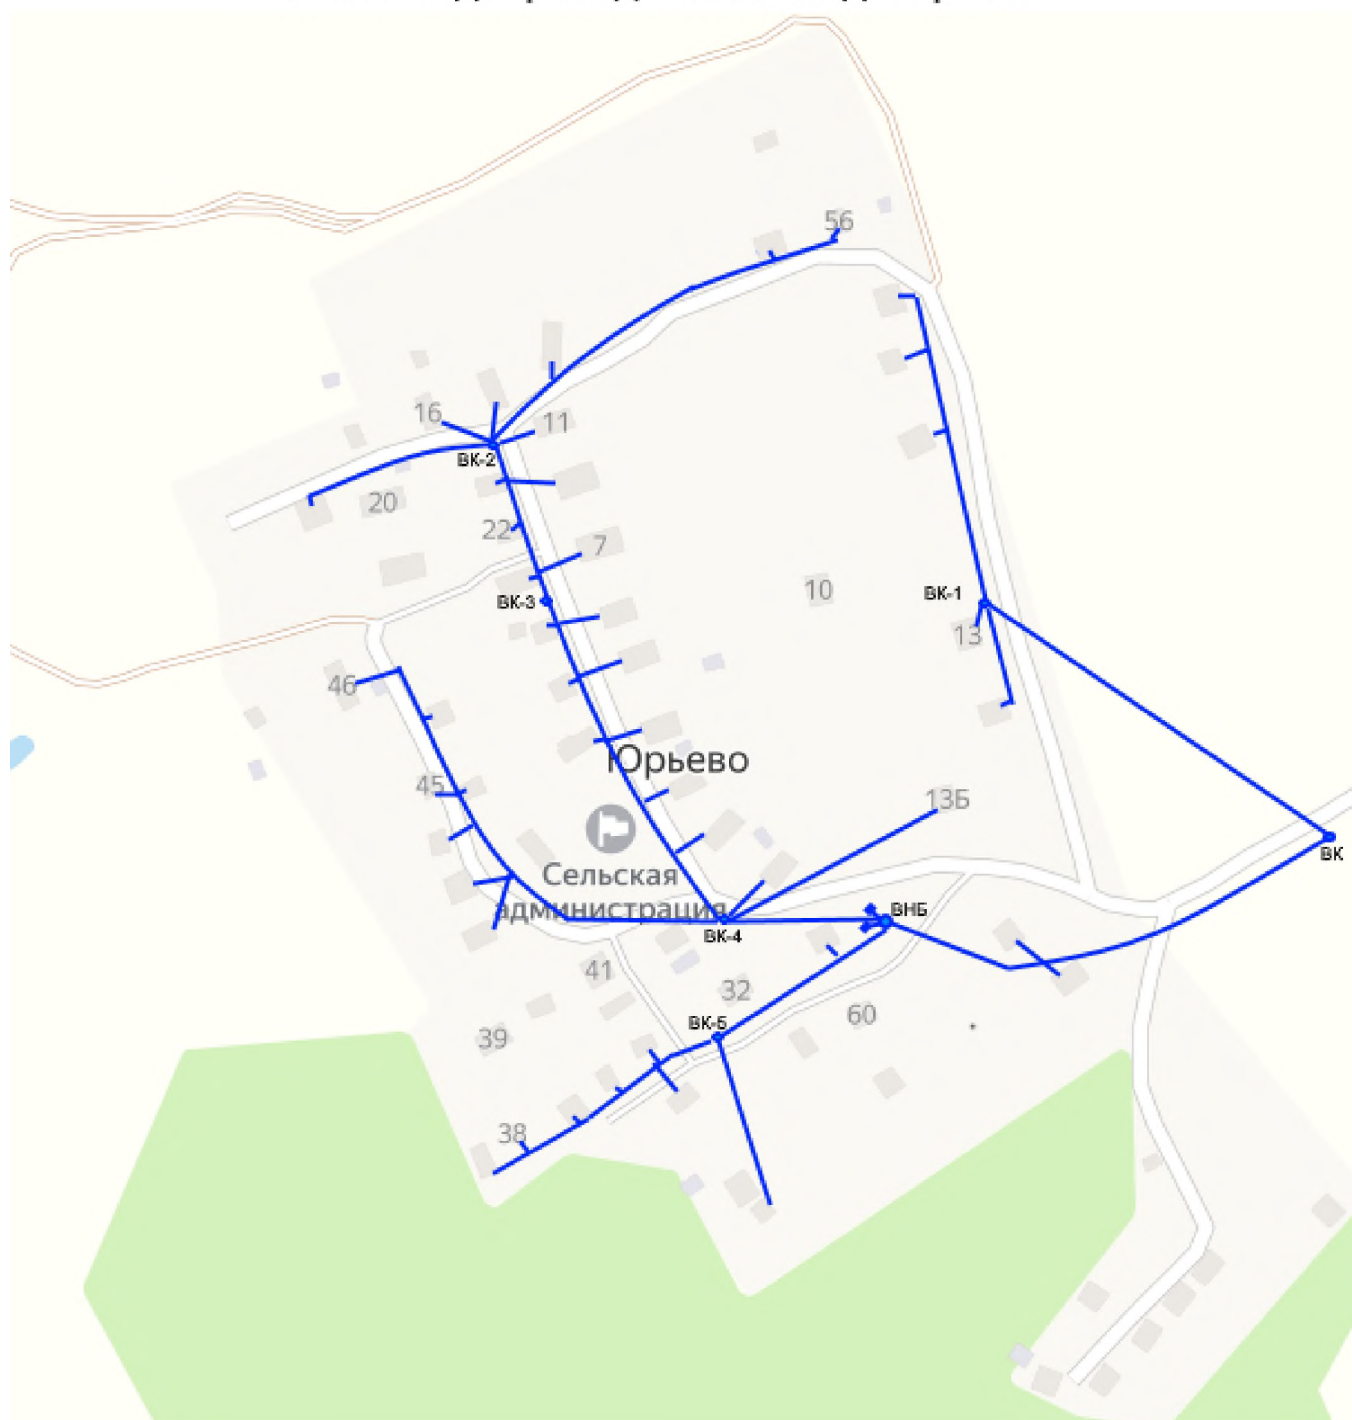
Схема водопроводных сетей д. Юрьево
